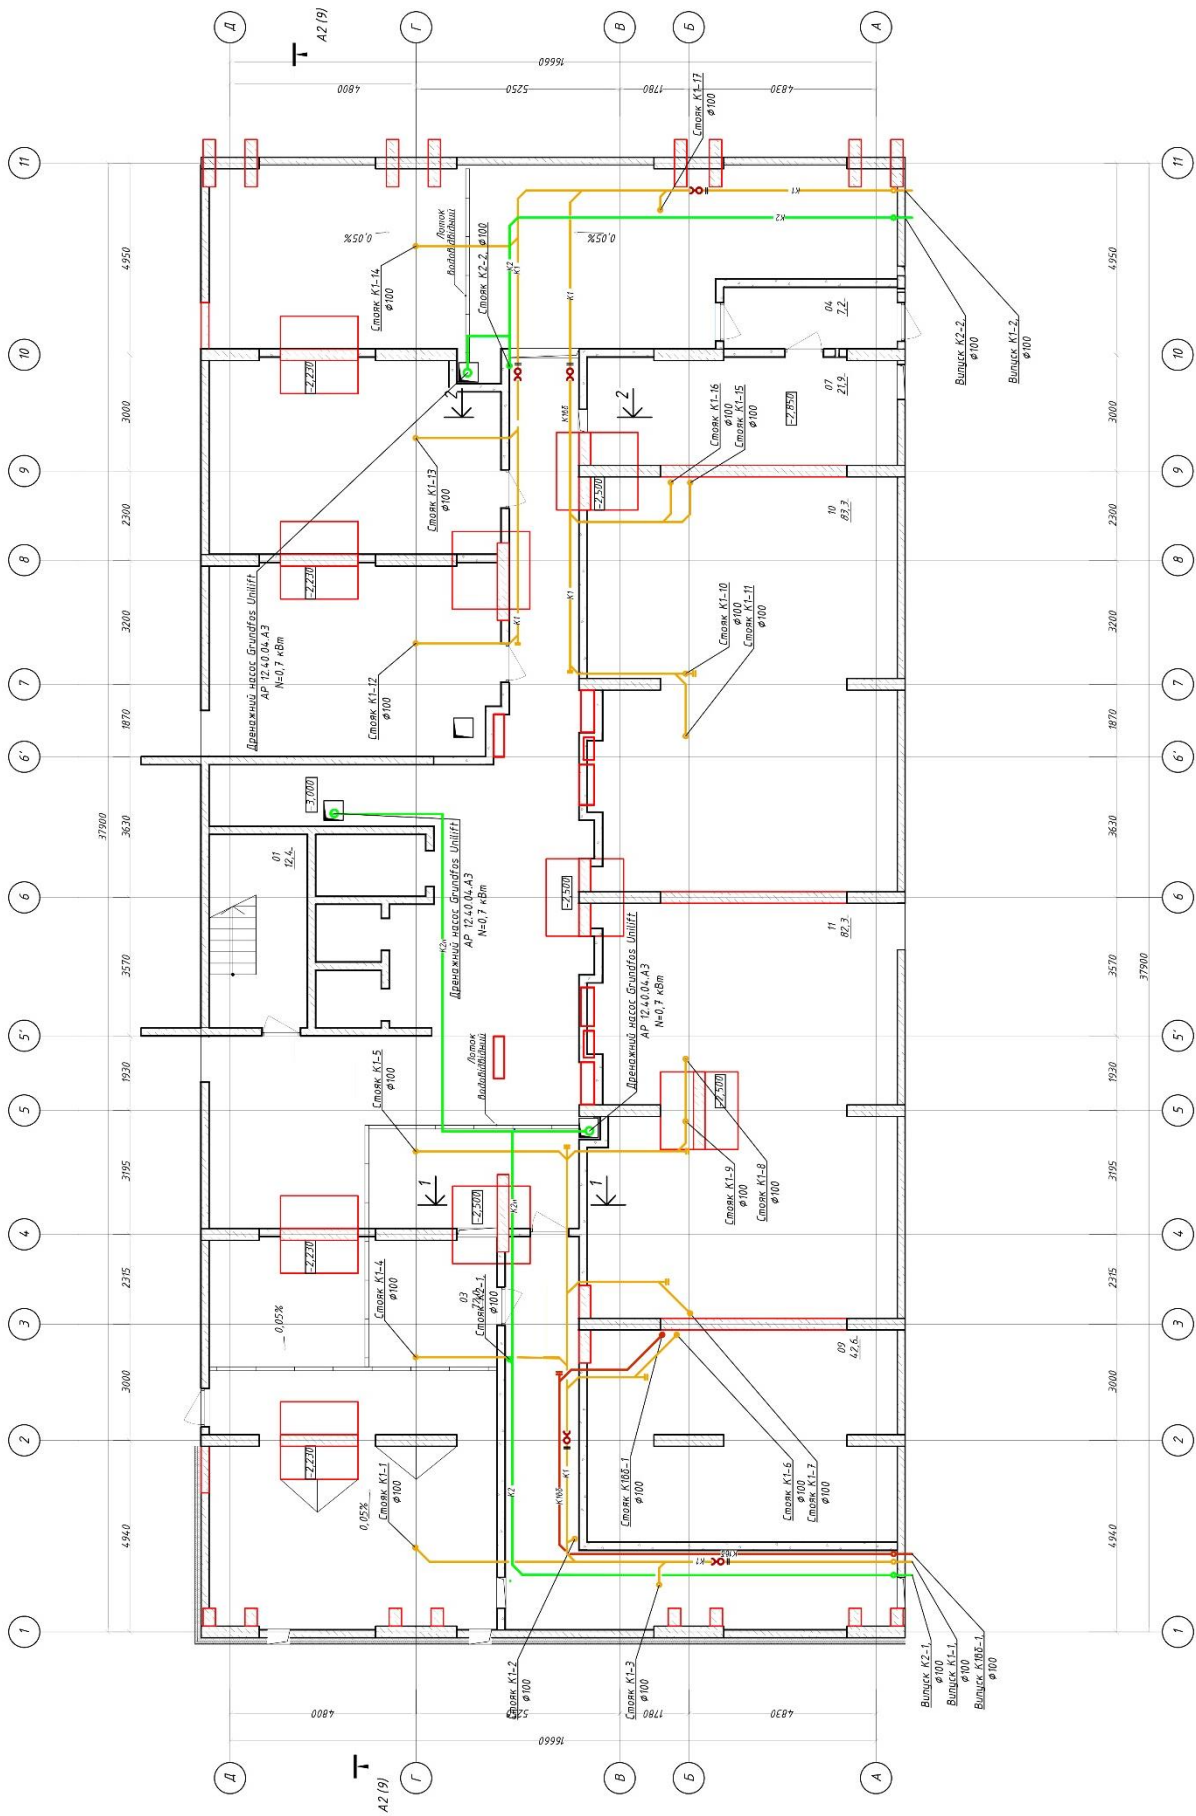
План підвального приміщення зі схемою розташування каналізаційної мережі
